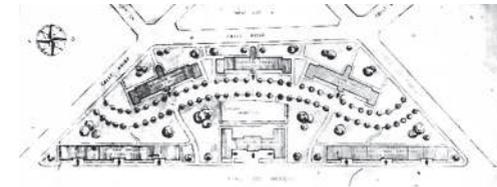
Planta Conjunto Habitacional Aníbal Pinto, 1939-1942. Idea de Bloques Armónico. (archivo C.Galeno).
